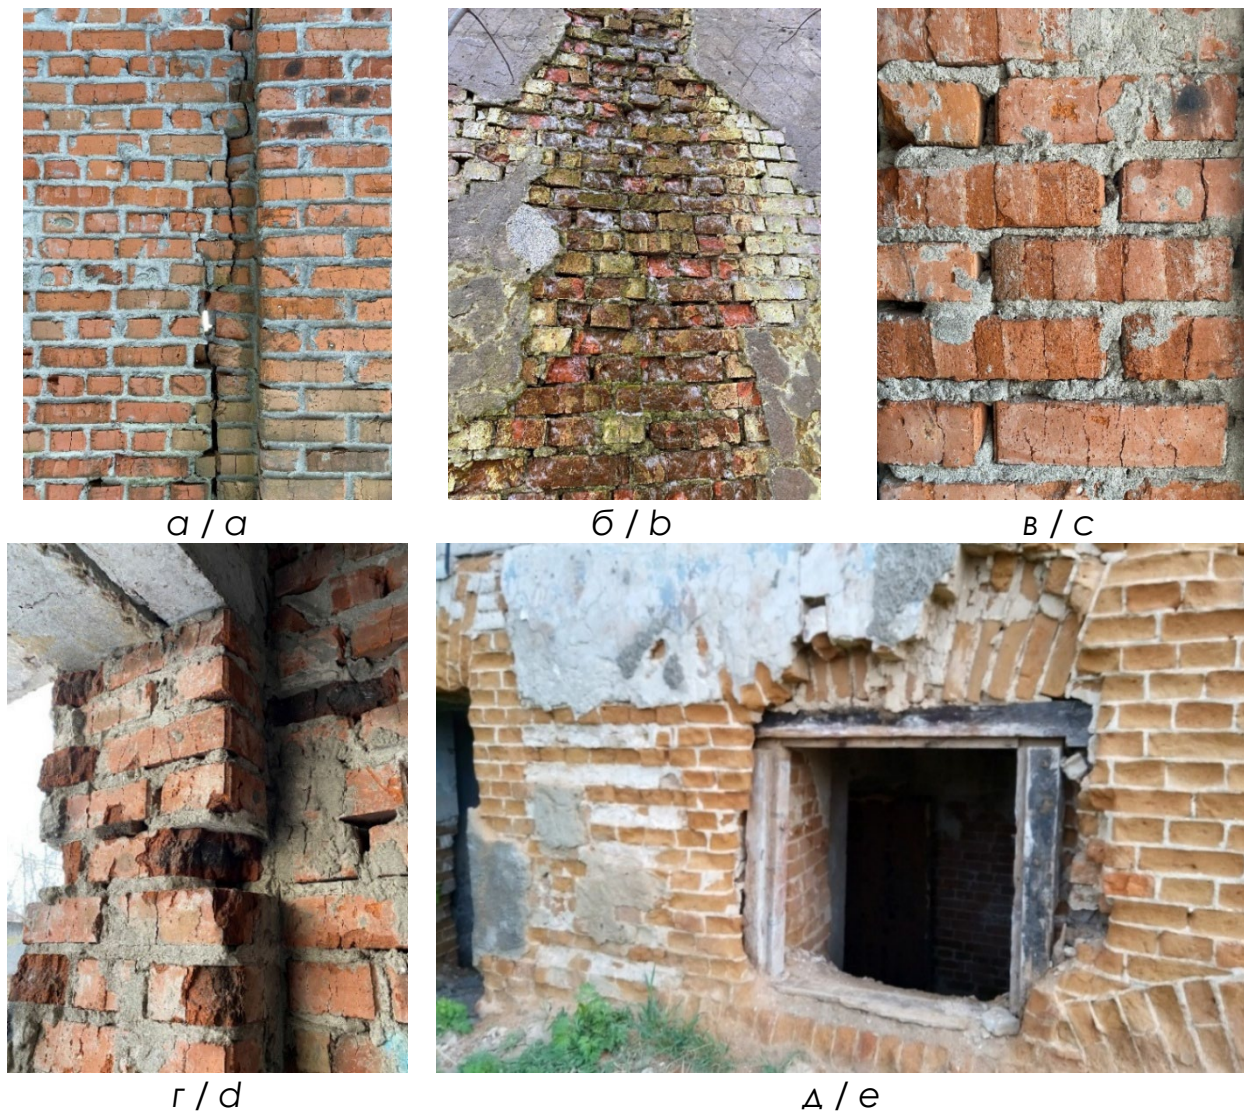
Дефекти кам'яної кладки:
